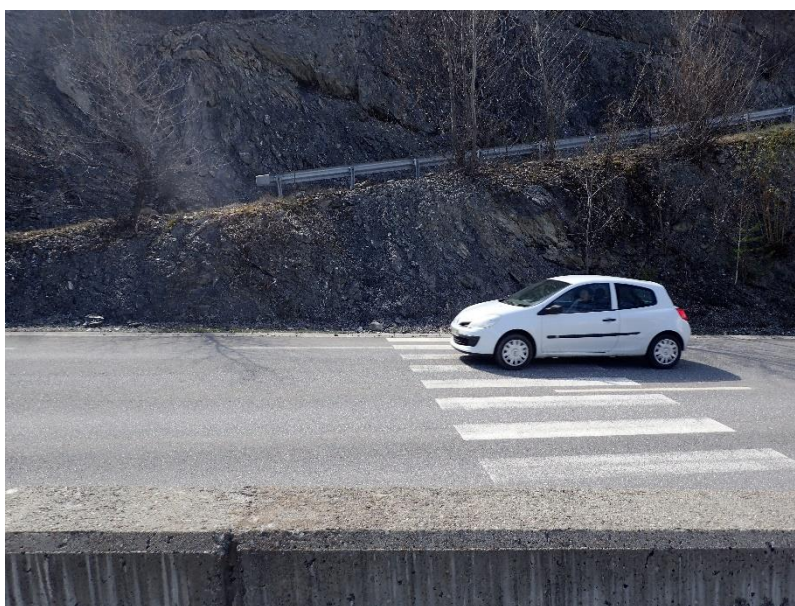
Accès piéton depuis le parking du Priouré vers la Place du Portail
